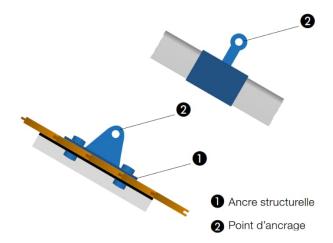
Classe A2 - Exemples d'ancres structurelles conçues pour être fixées sur des toits inclinés
